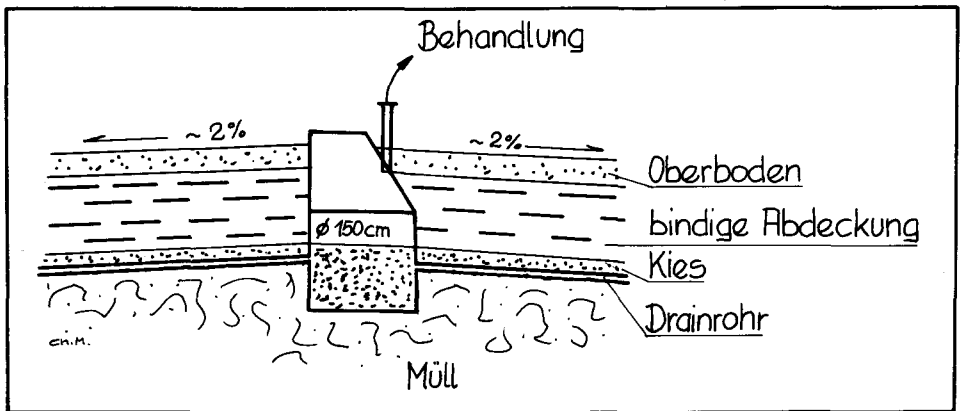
Abfuhr von Deponiegas durch Flächendrainage mit Drainrohren (nach LAGA 6, 1983).
